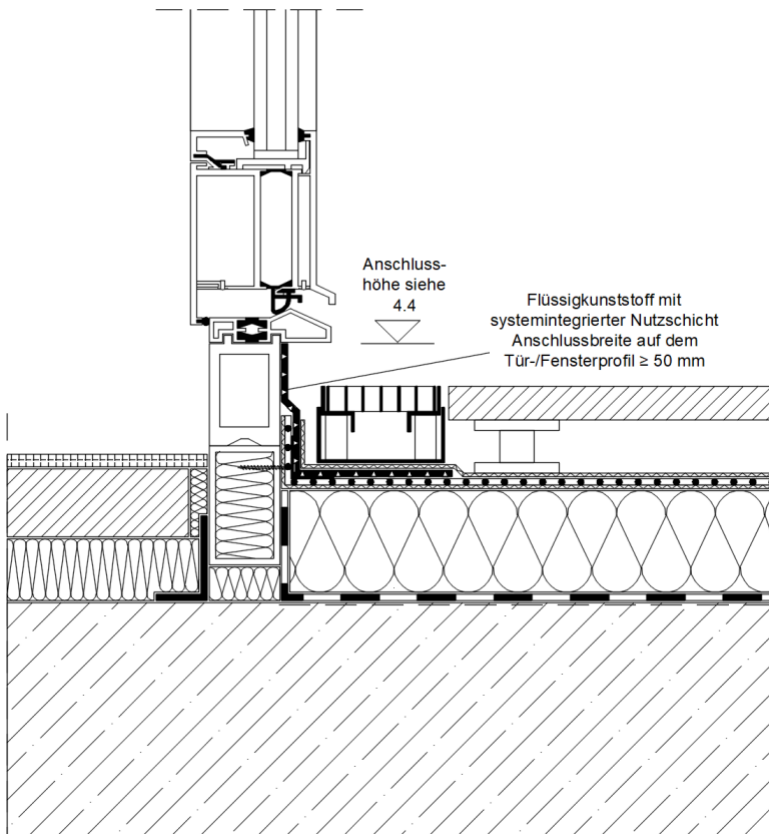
Terrassentüranschluss mit Entwässerungsrinne – Ausführung mit Flüssigkunststoff (im Anschlussbereich mit systemintegrierter Nutzschrift – Anschlusshöhe  $\geq 5$  cm (durchgehende Deckenplatte)
